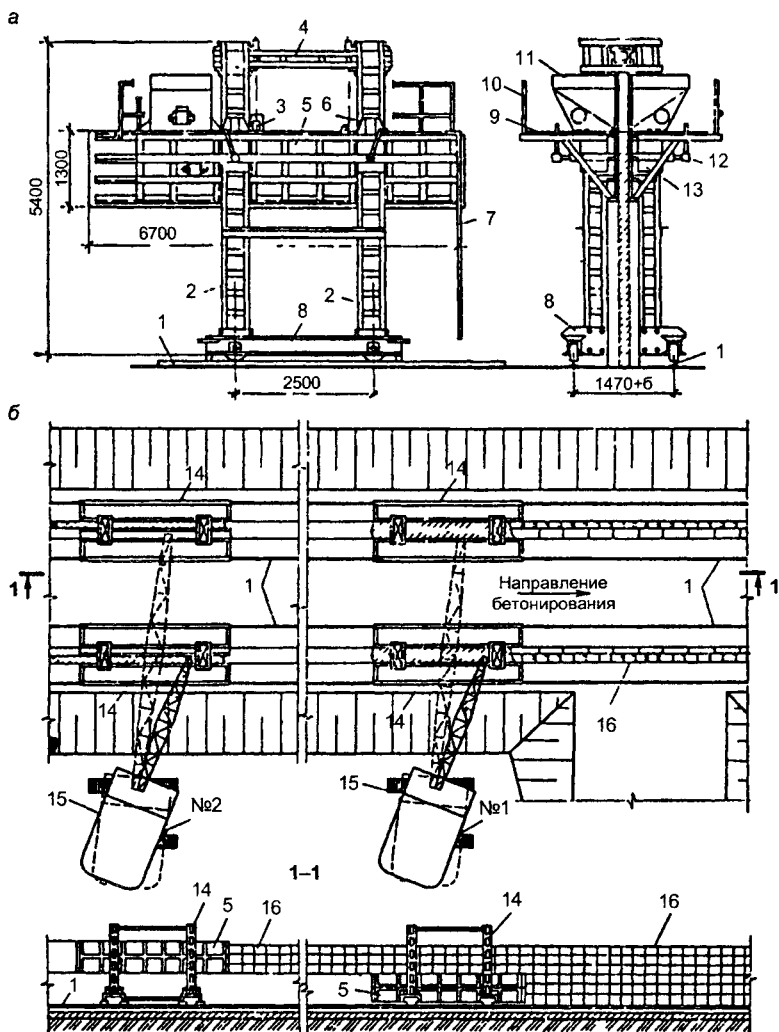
Бетонирование стен прямоугольного отстойника с помощью горизонтально скользящей опалубки:
